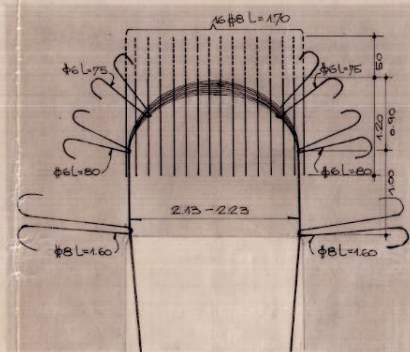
15 Plantilla vigas; alzado bóveda exterior izquierda
